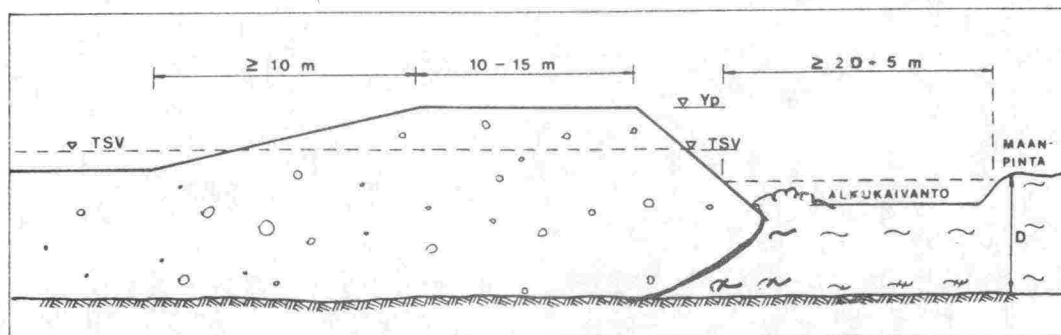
Esimerkki massanvaihdon poikkileikkauksesta. Murtoviivaa, joka alkaa tien reunasta kaltevuudessa 1:1 ja jatkuu 2:1 käytetään massanvaihdon leveyden määrittelyyn tasolla, johon massanvaihto ulotetaan.
